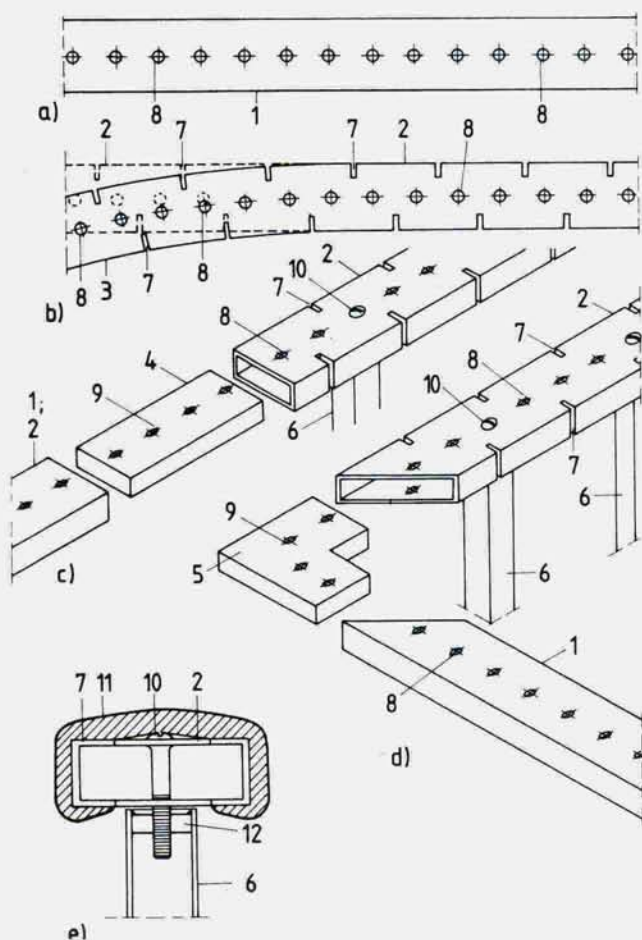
Поручень из металлических планок с прямым и зубчатым профилем
